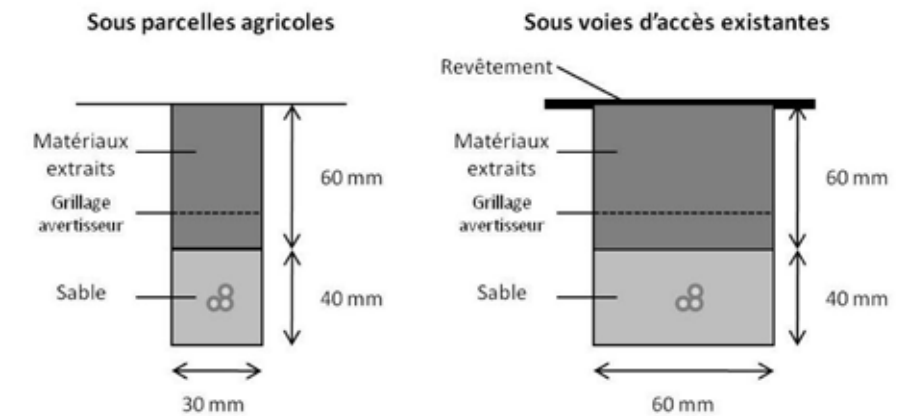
Exemple de tranchée pour la mise en place de câbles souterrains
